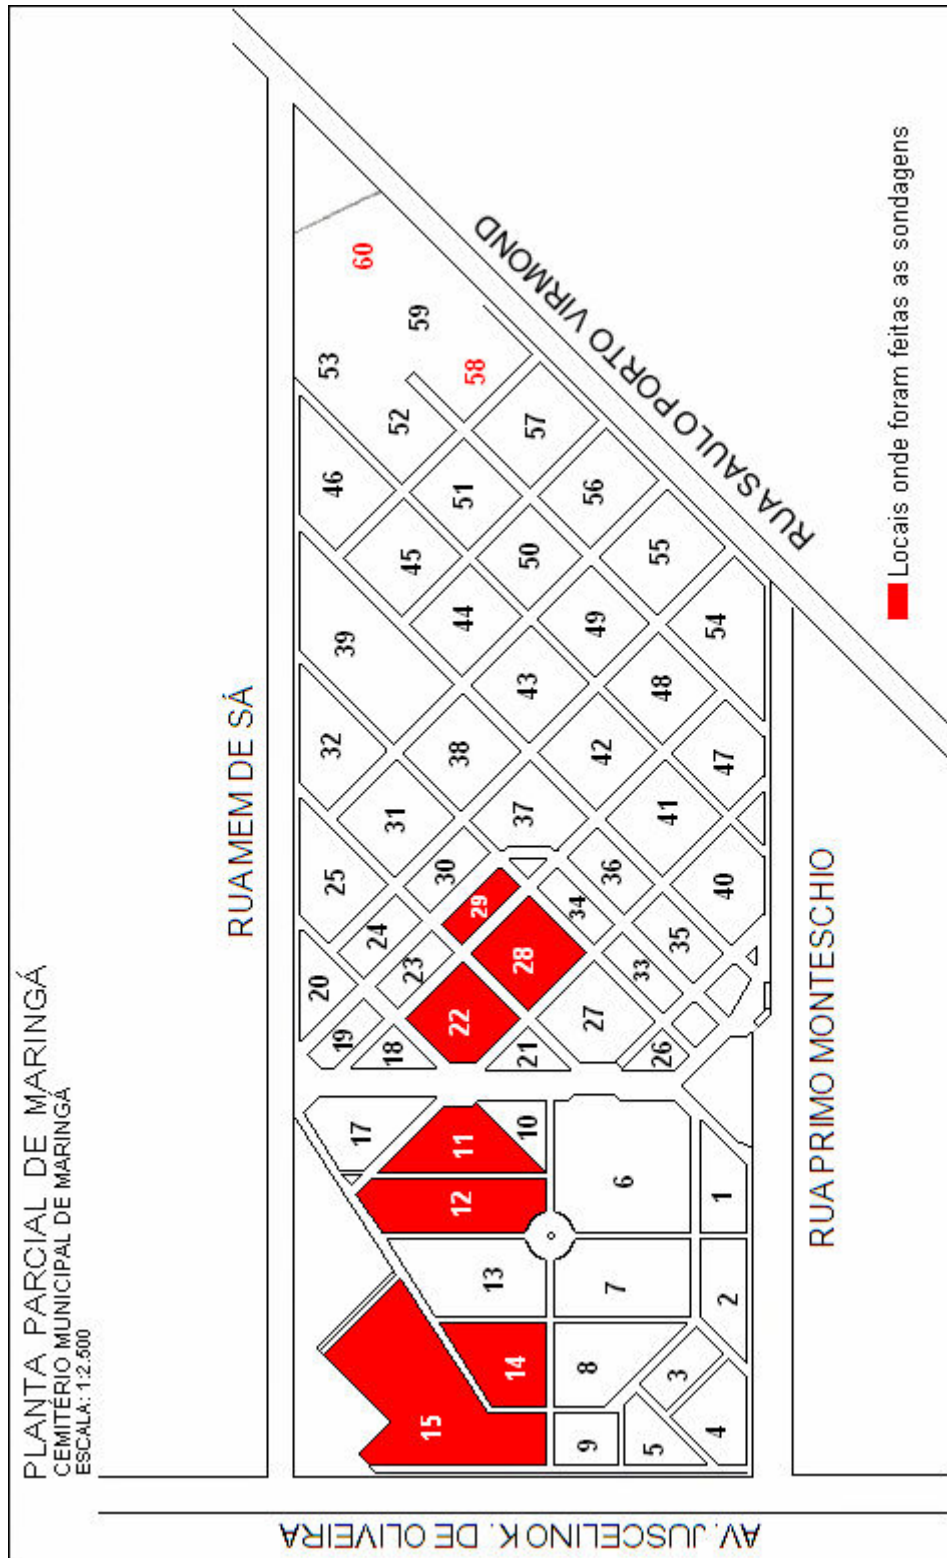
Planta baixa do Cemitério Jardim Municipal de Maringá
